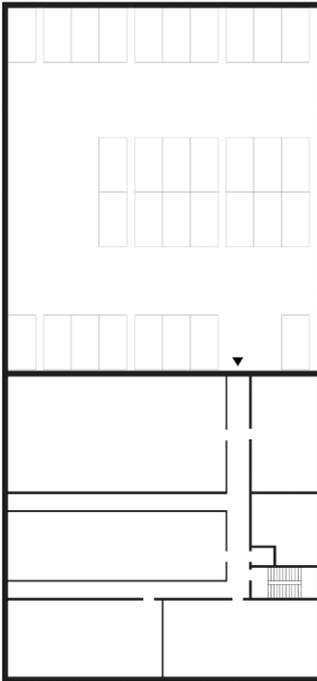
Vorentwurf Grundriss Untergeschoss SGA
